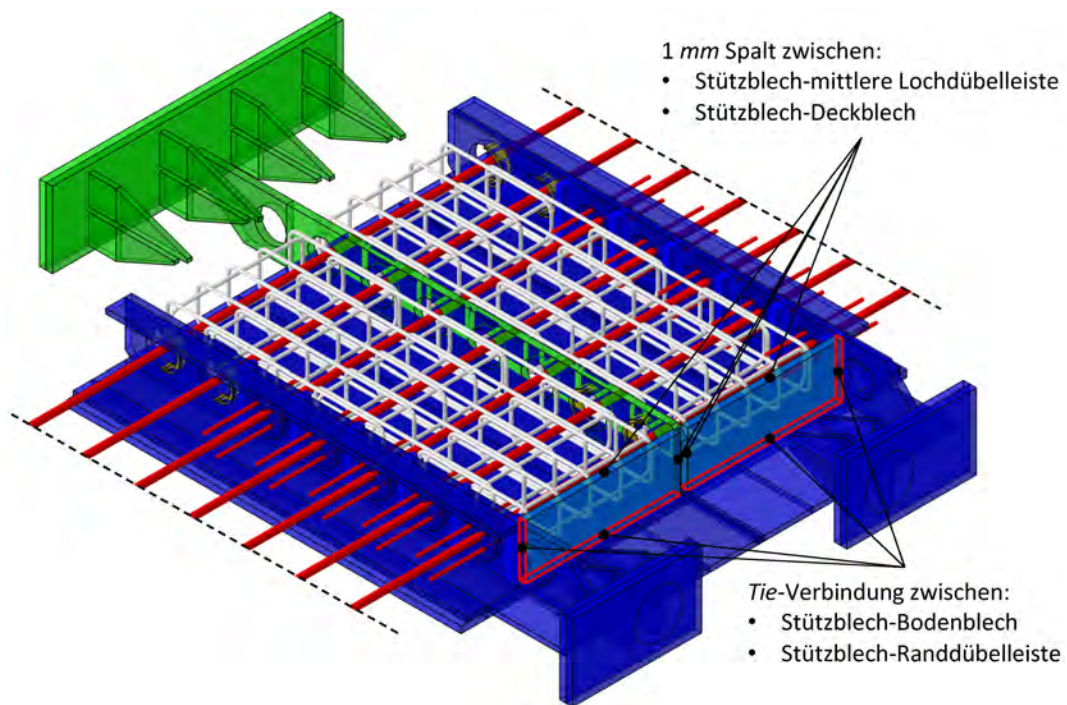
Versuchskörper VK1/5, mit Zug, mit Längs- und Bügelbewehrung und Stützblech
